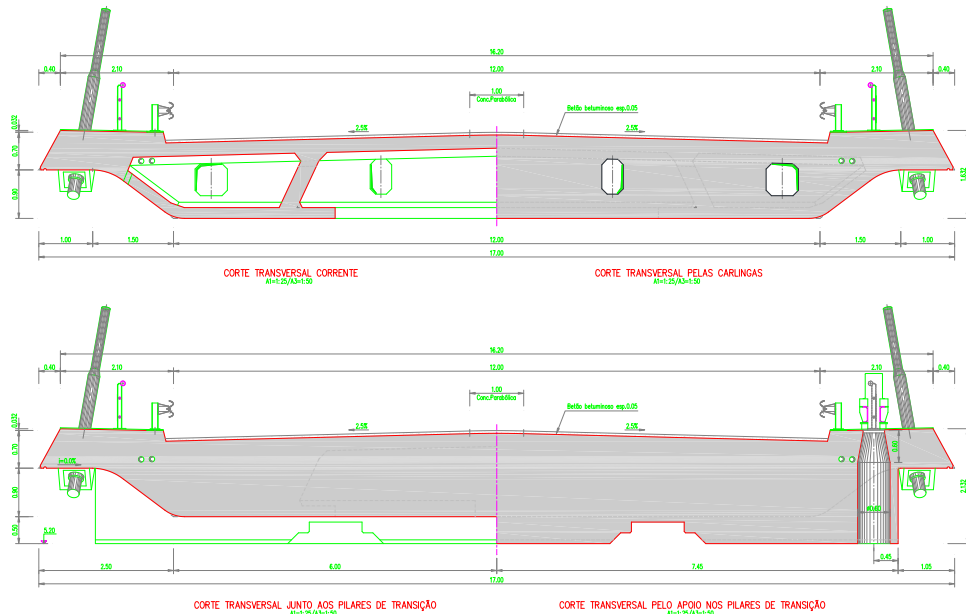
Seção transversal do tabuleiro – Trecho estaiado e pilar de transição
